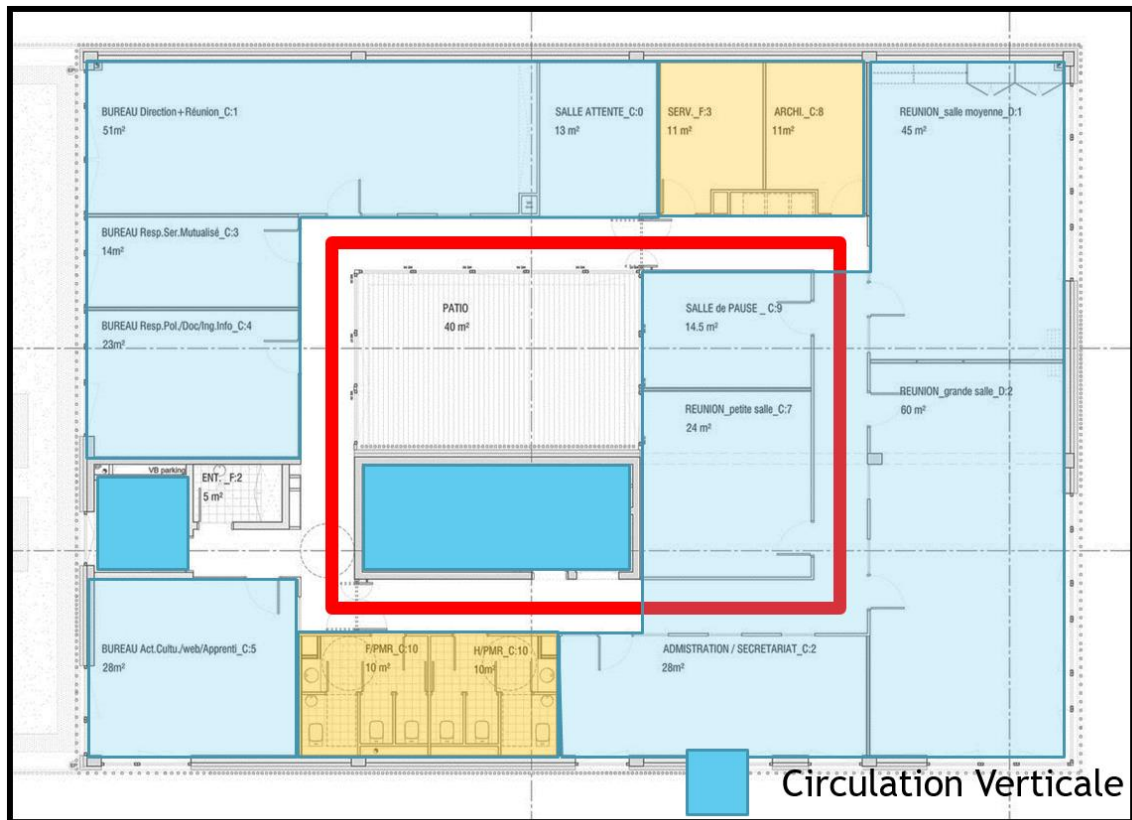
Plan du 2eme Etage (Source : Archdaily.com)
